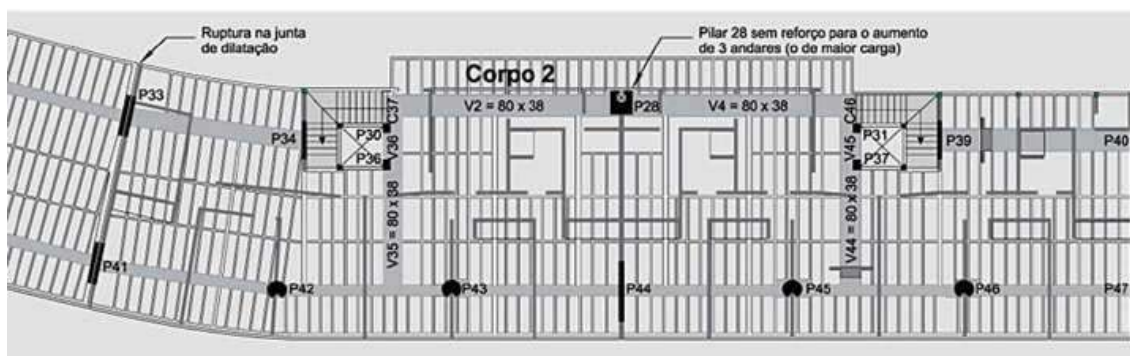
Planta do pavimento tipo do Edifício Comurba (VASCONCELOS, 1998)
